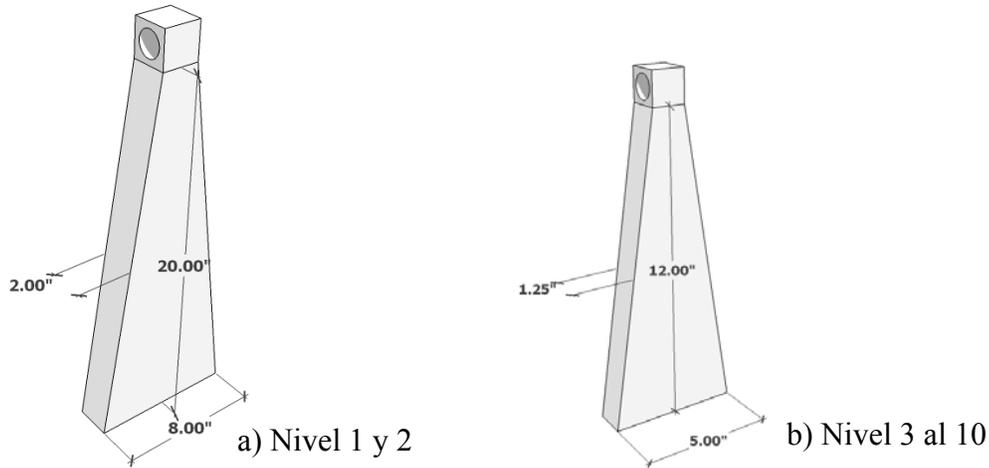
Placas tipo TADAS y dimensiones propuestas
